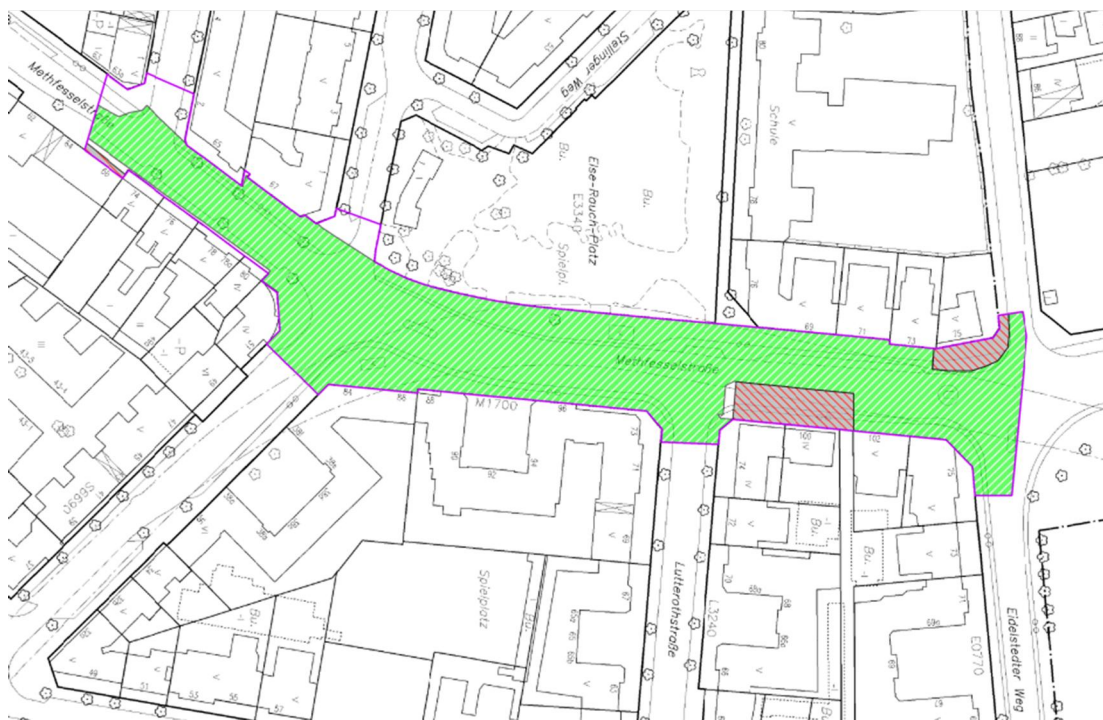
Auszug aus Lageplan zur Stellungnahme mit Verdachtsflächen
